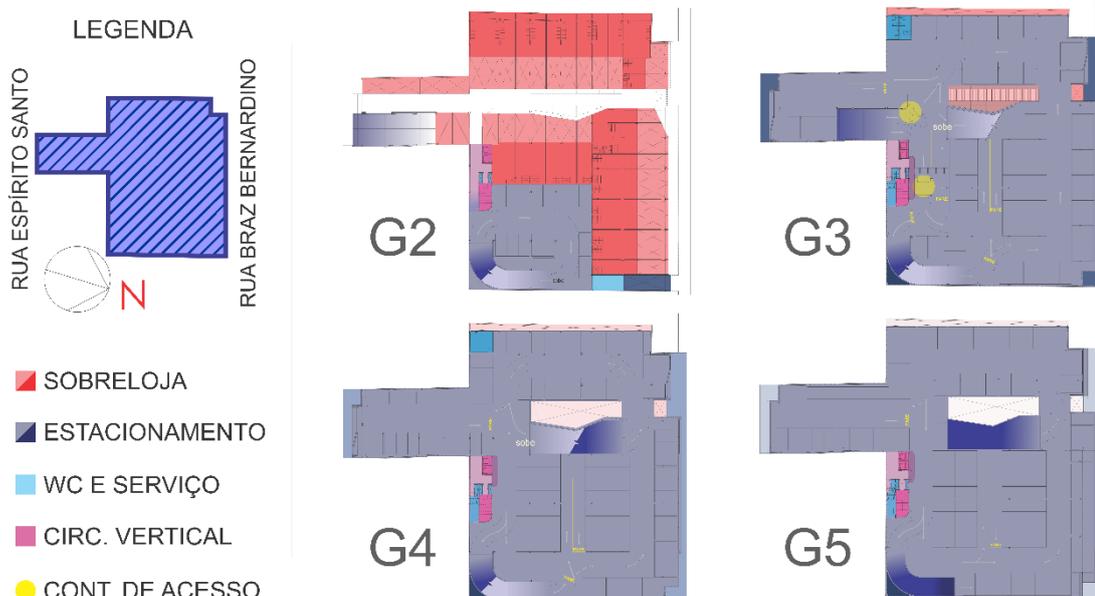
Pátio Central, planta baixa, pavimentos de garagem.
